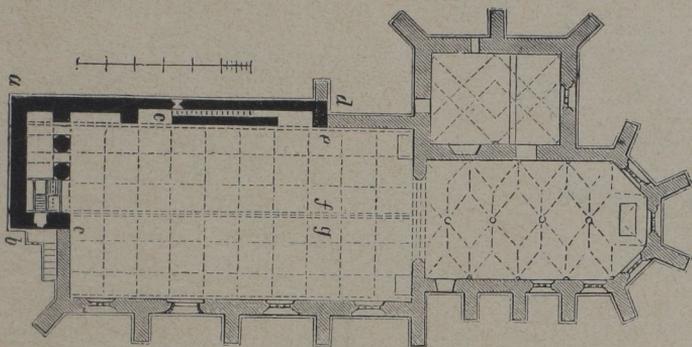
Grundriss der Ägidikirche in Mühlhausen.
